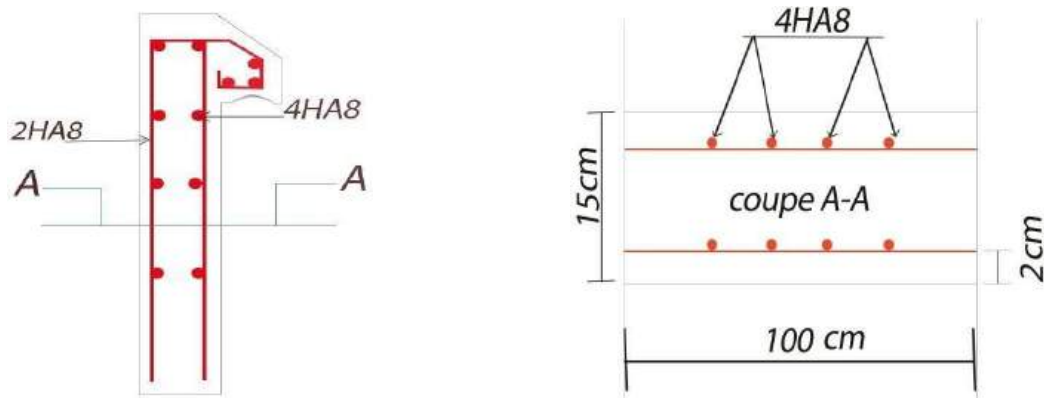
Schéma de ferrailage de l'acrotère.
